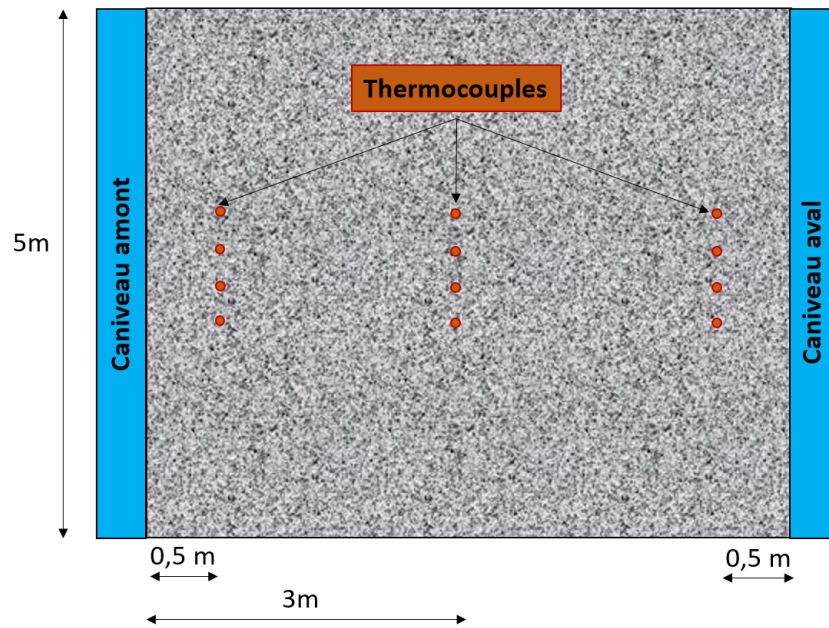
Plan d’implantation des thermocouples dans la chaussée
